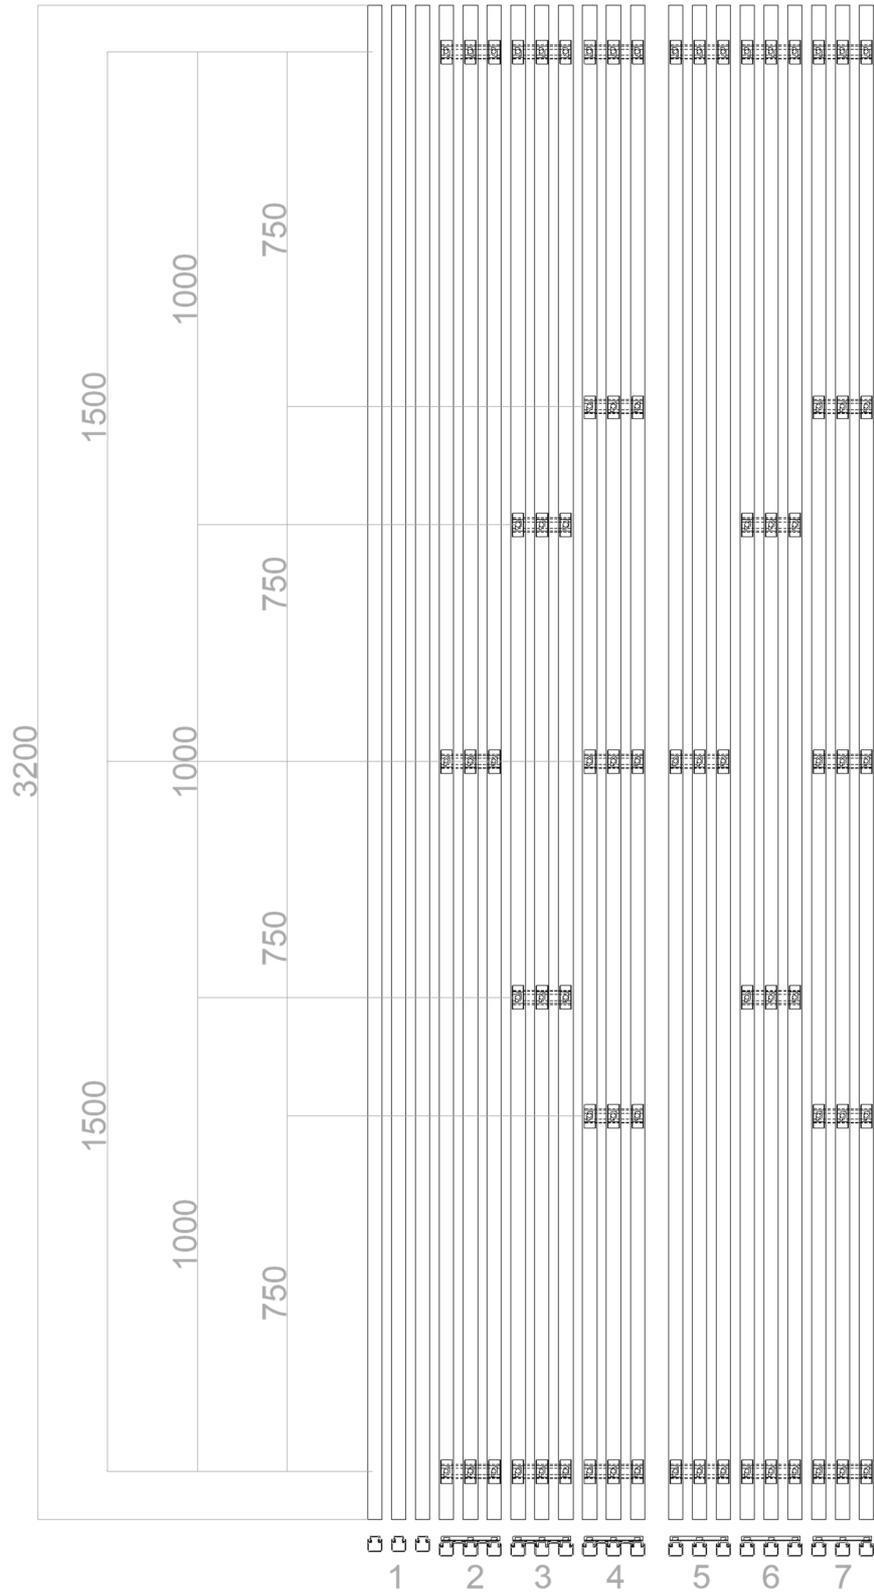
Prospetto e sezione del campione sottoposto a prova_Batters 30
